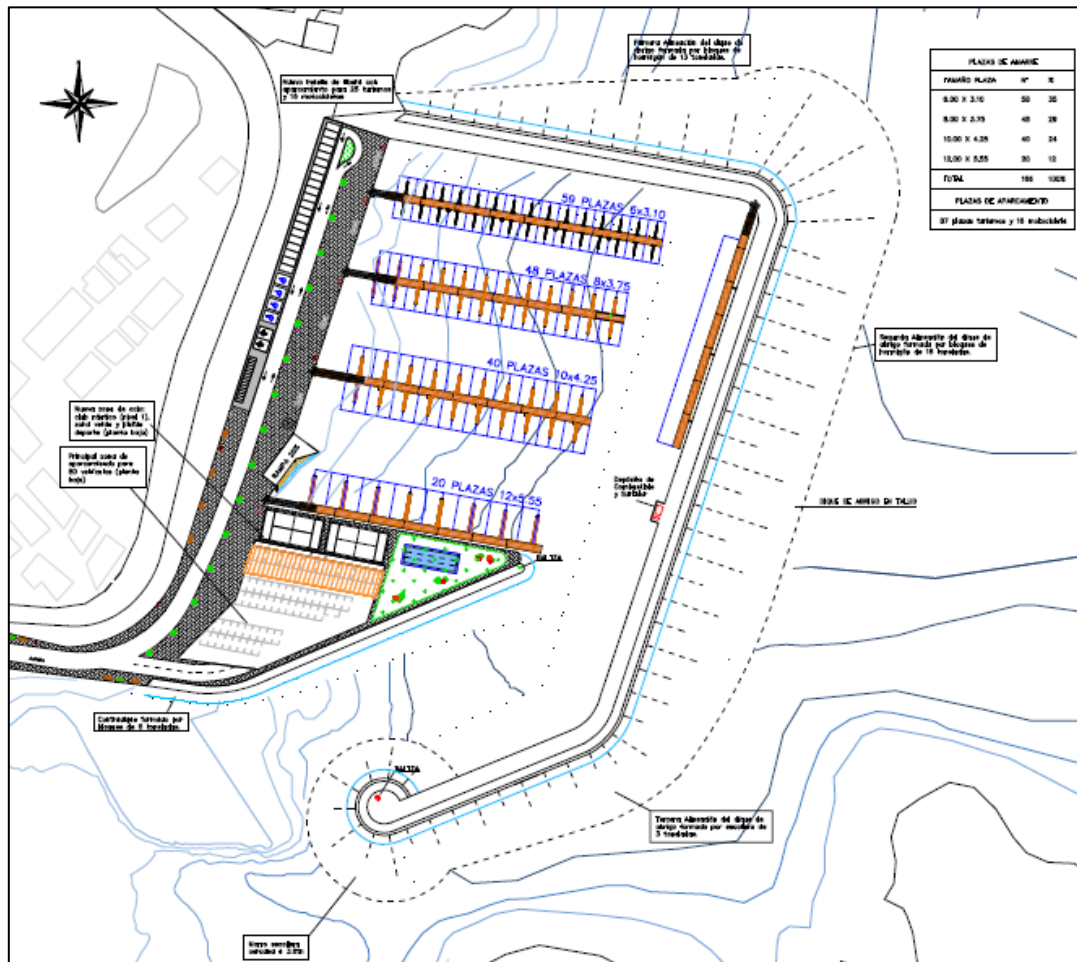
Planta General del Nuevo Puerto deportivo de Cerberè
